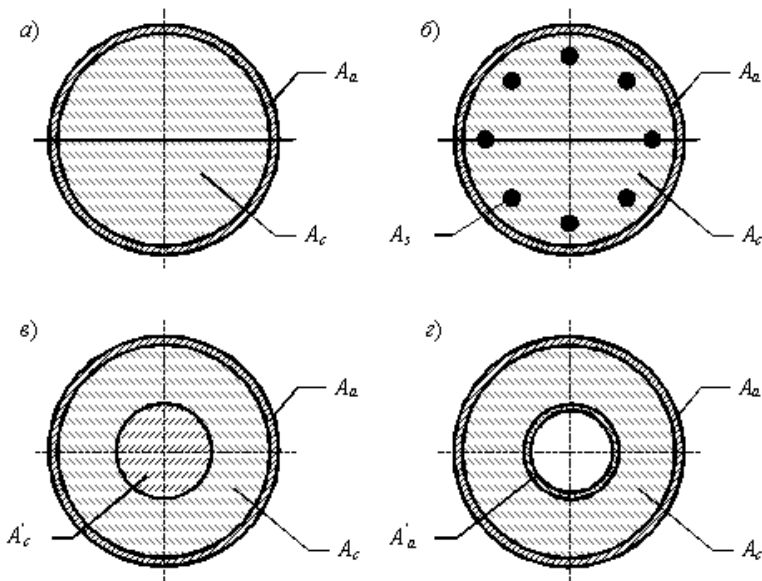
Поперечні перерізи трубобетонних елементів зі зміцненим осердям: а – високоміцним бетоном; б – стрижневим армуванням; в – багатошаровим бетоном; з – багатошаровою оболонкою
